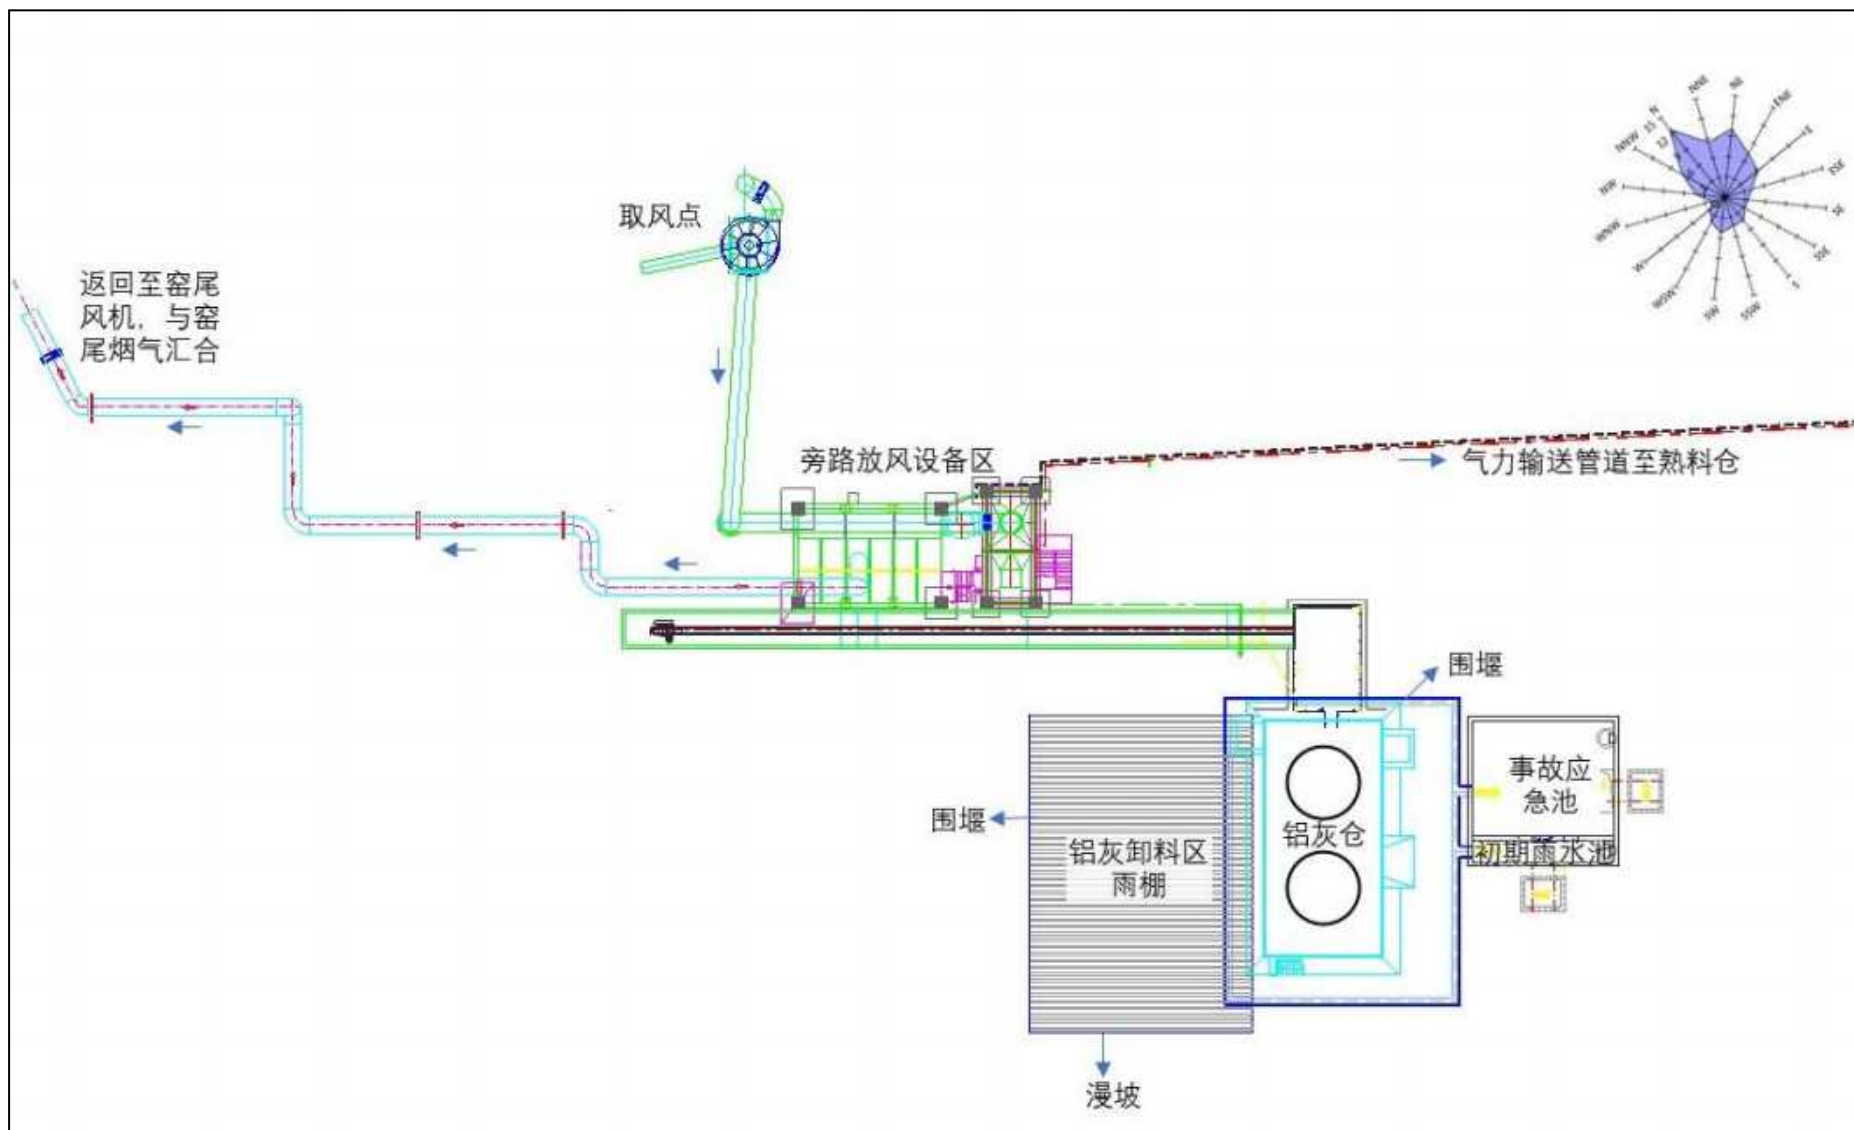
水泥窑协同处置铝灰项目（鑫达技改项目一期工程）新增设施平面布置图
